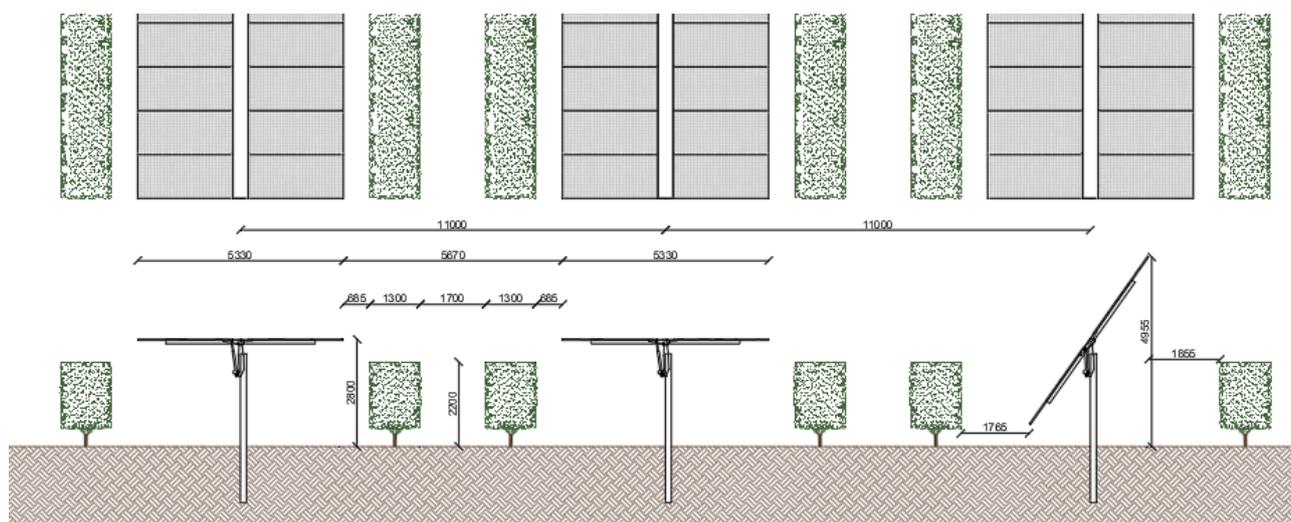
Sezione tipo dell'assetto agrovoltaico
